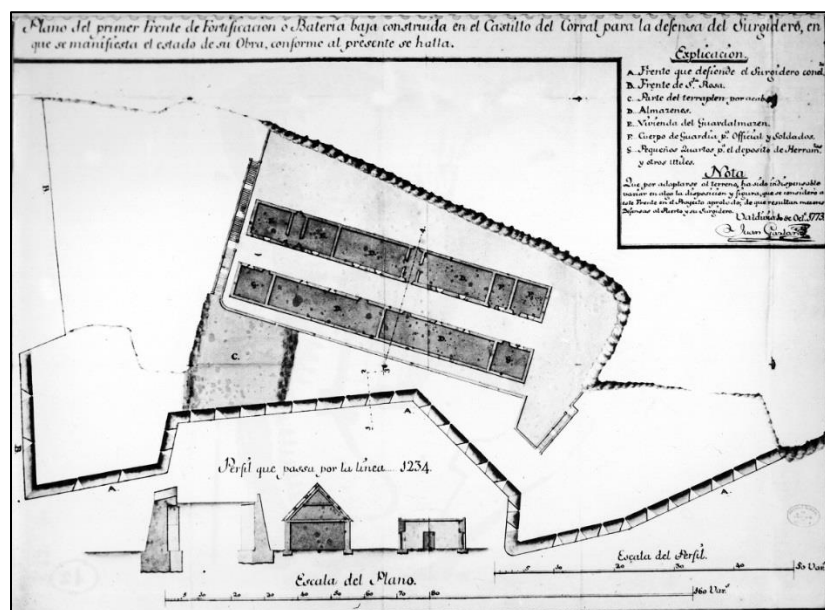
Plano levantado del fuerte Corral dibujado el año 1773 mostrando el estado de avance de las obras por aquel año. [Fuente: Montandón 2001, Tomo I].
